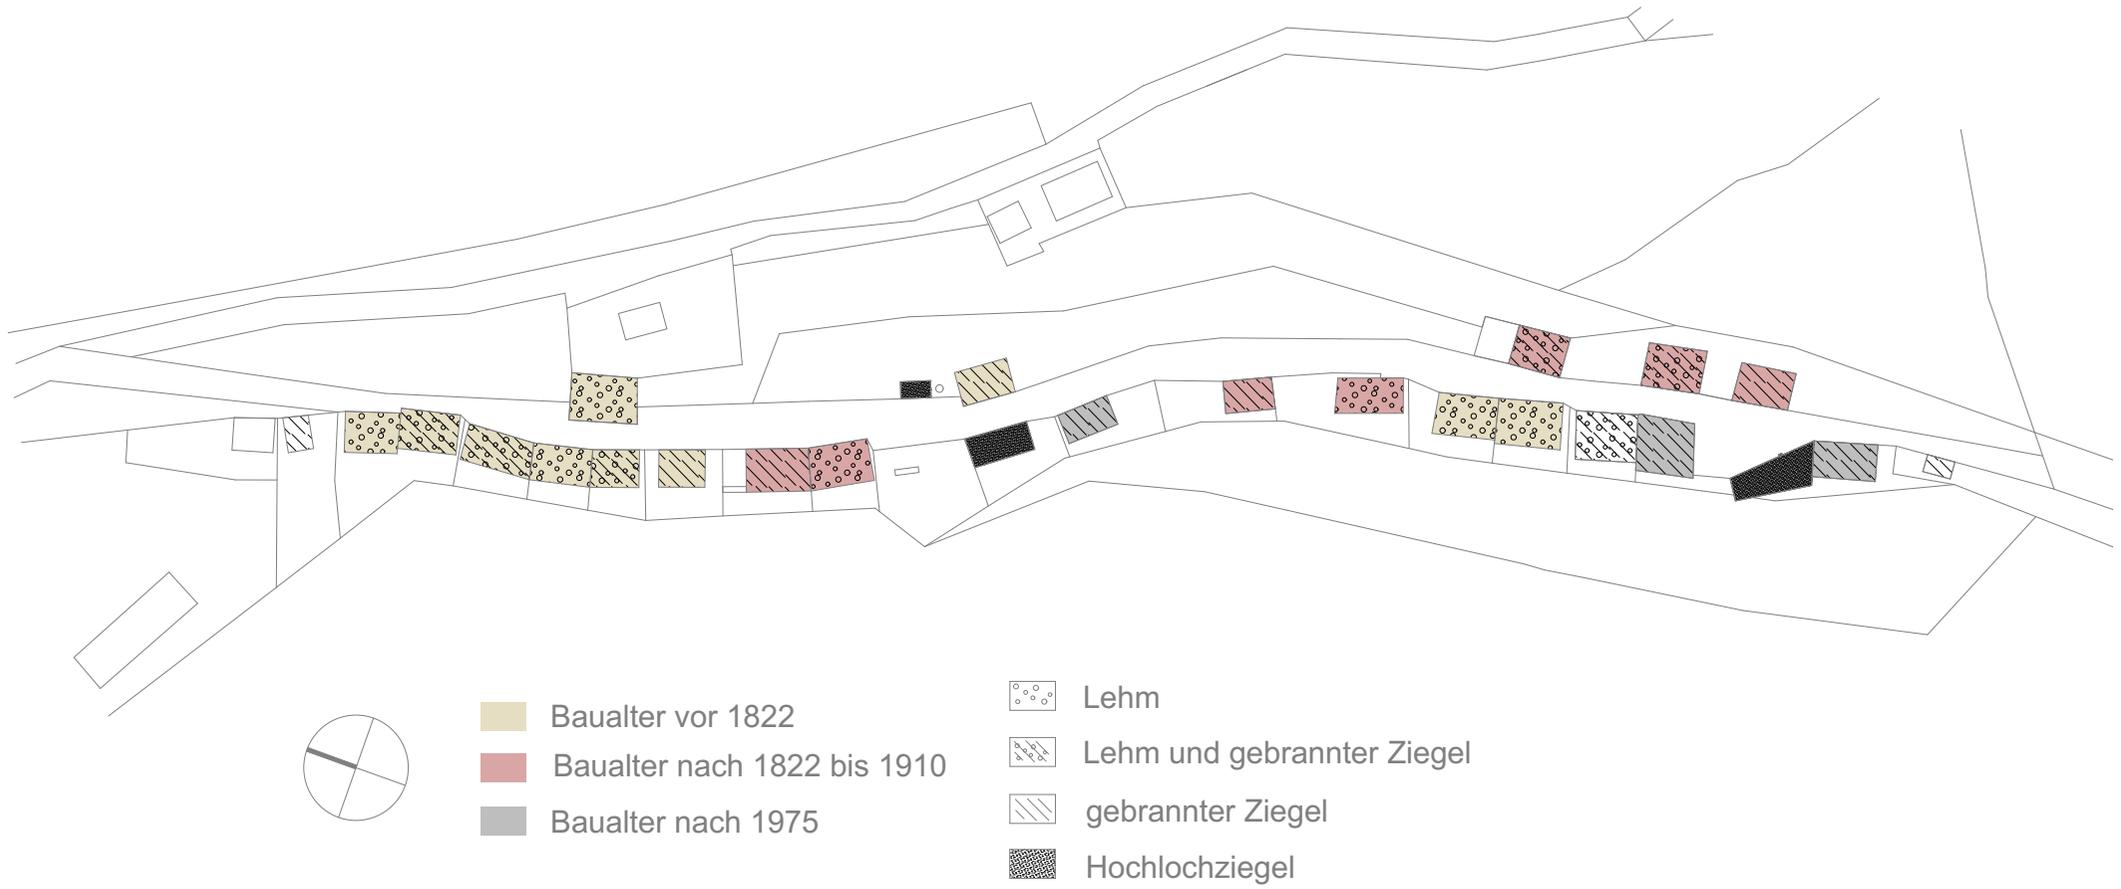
Lageplan Baualter und Materialien Maßstab 1:1000
